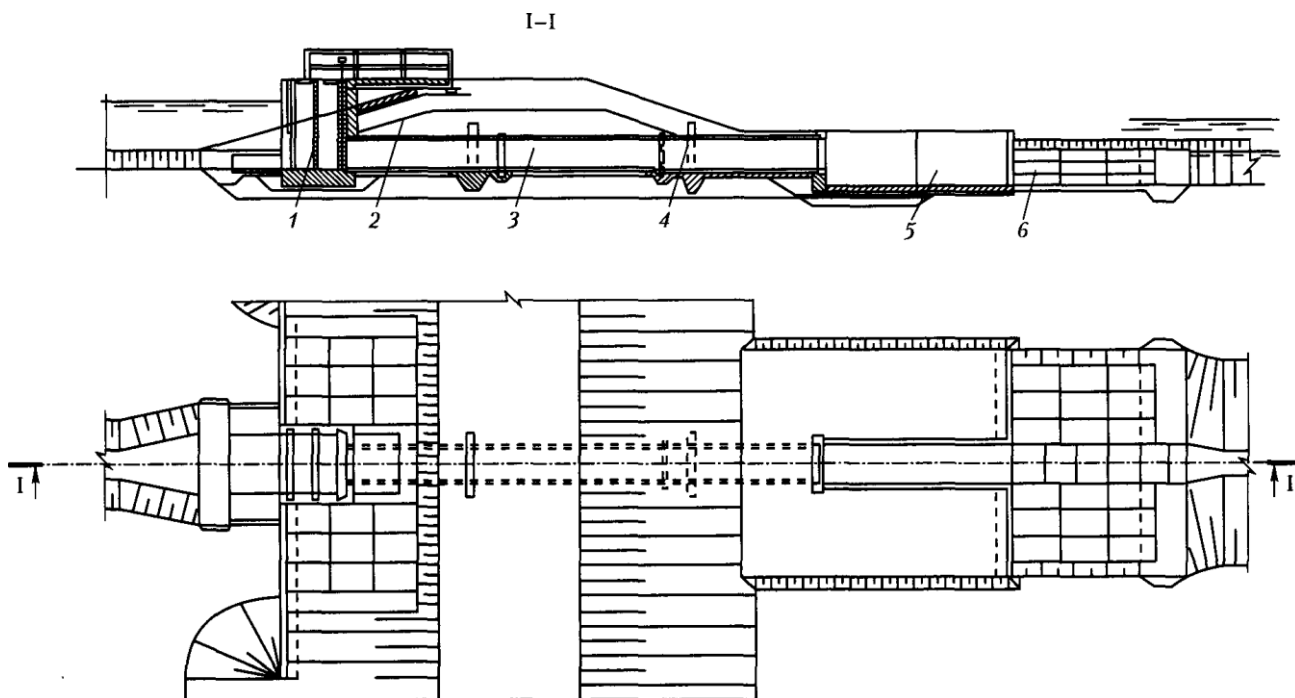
Башенный водоспуск из пруда в пруд (ОАО «Полесьегипроводхоз»):
